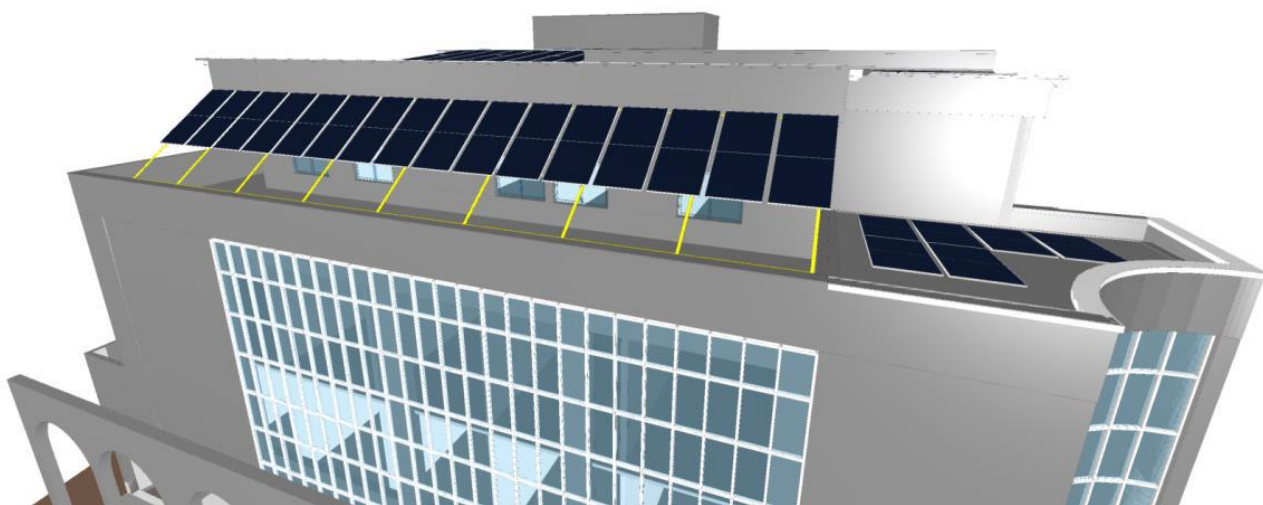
Vista dos 16 módulos que deverão ser instalados na varanda do 3º pavimento
